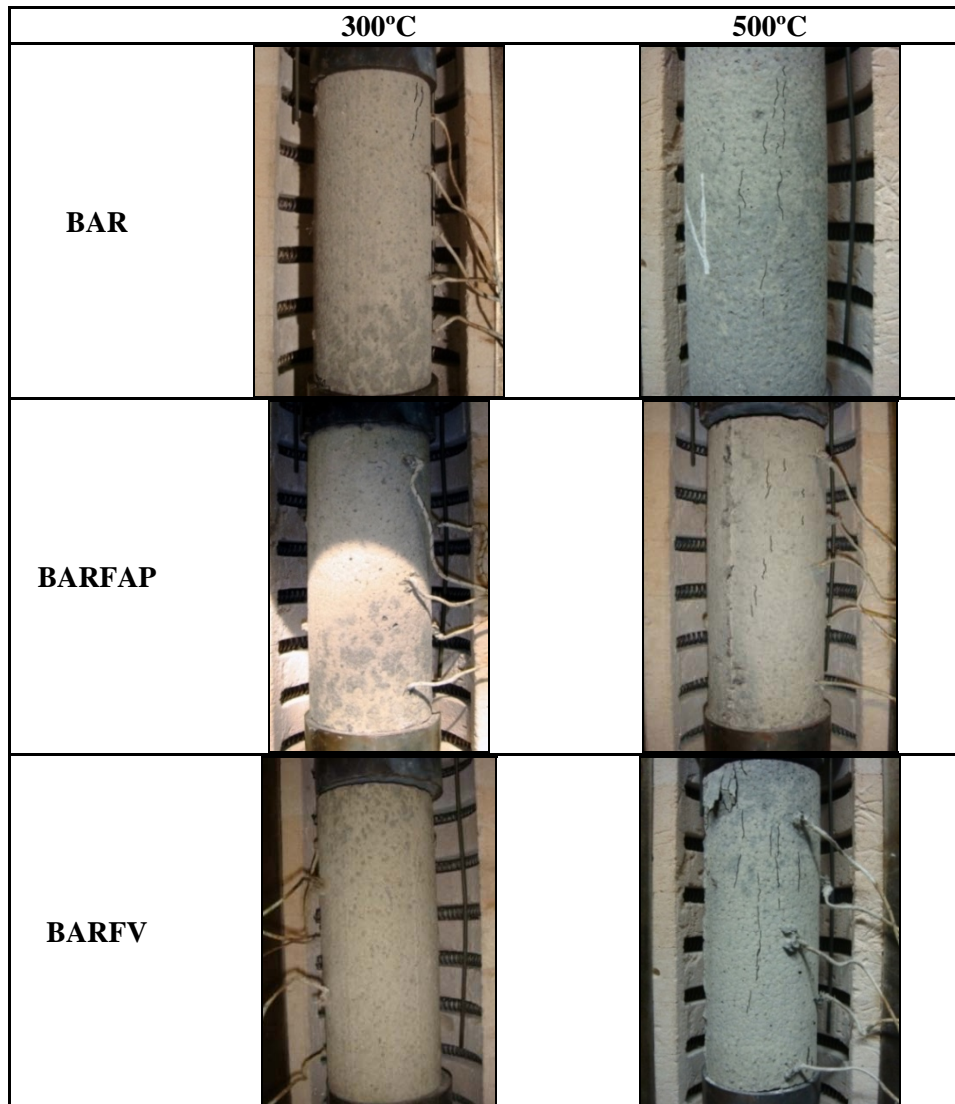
Provete após ensaio de aquecimento e arrefecimento.
